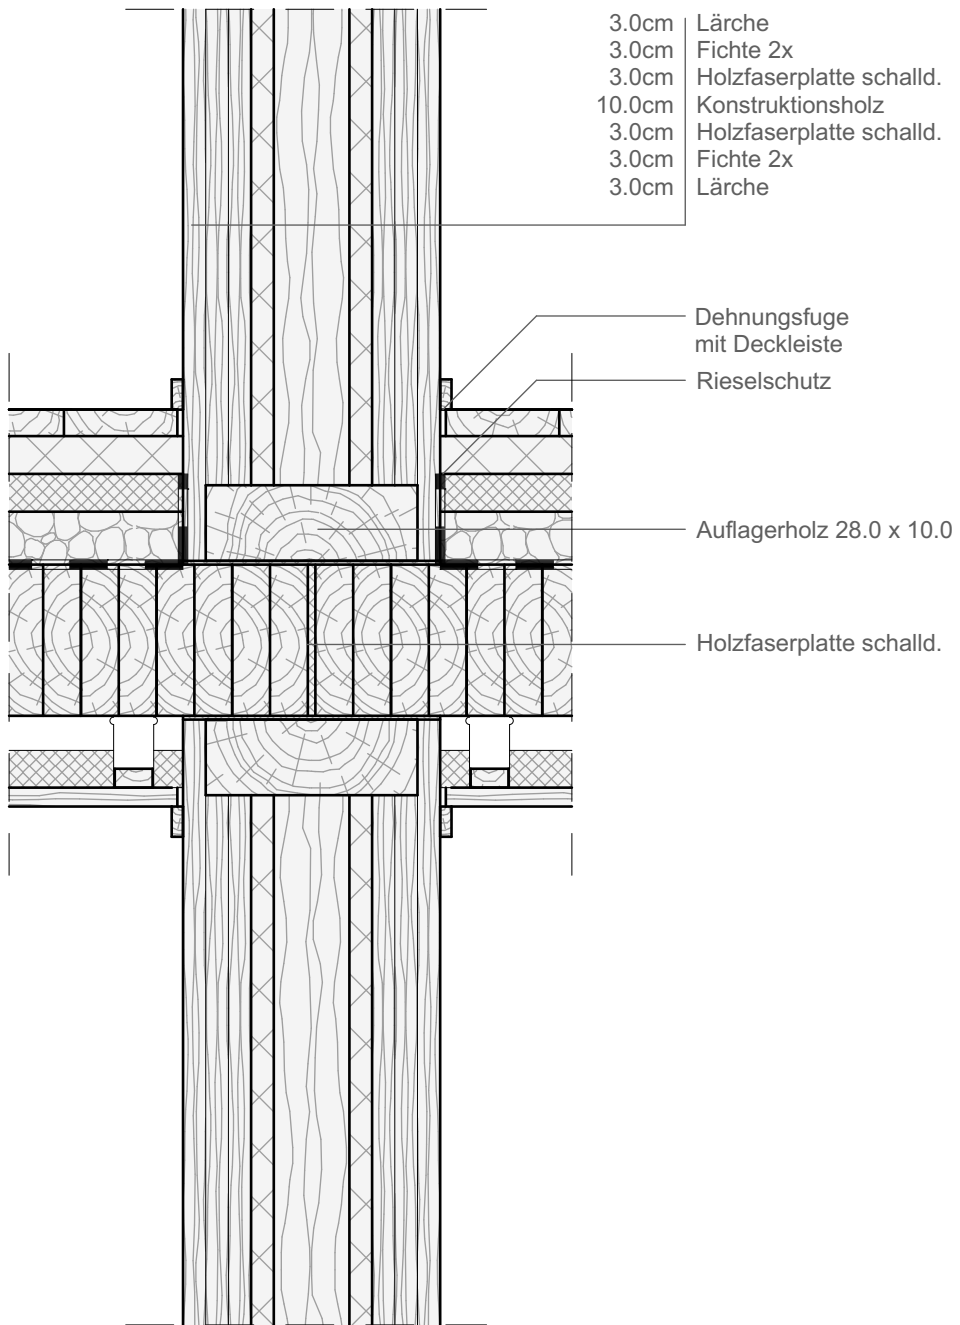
tragende Wohnungstrennwand - Detail M 1:10
